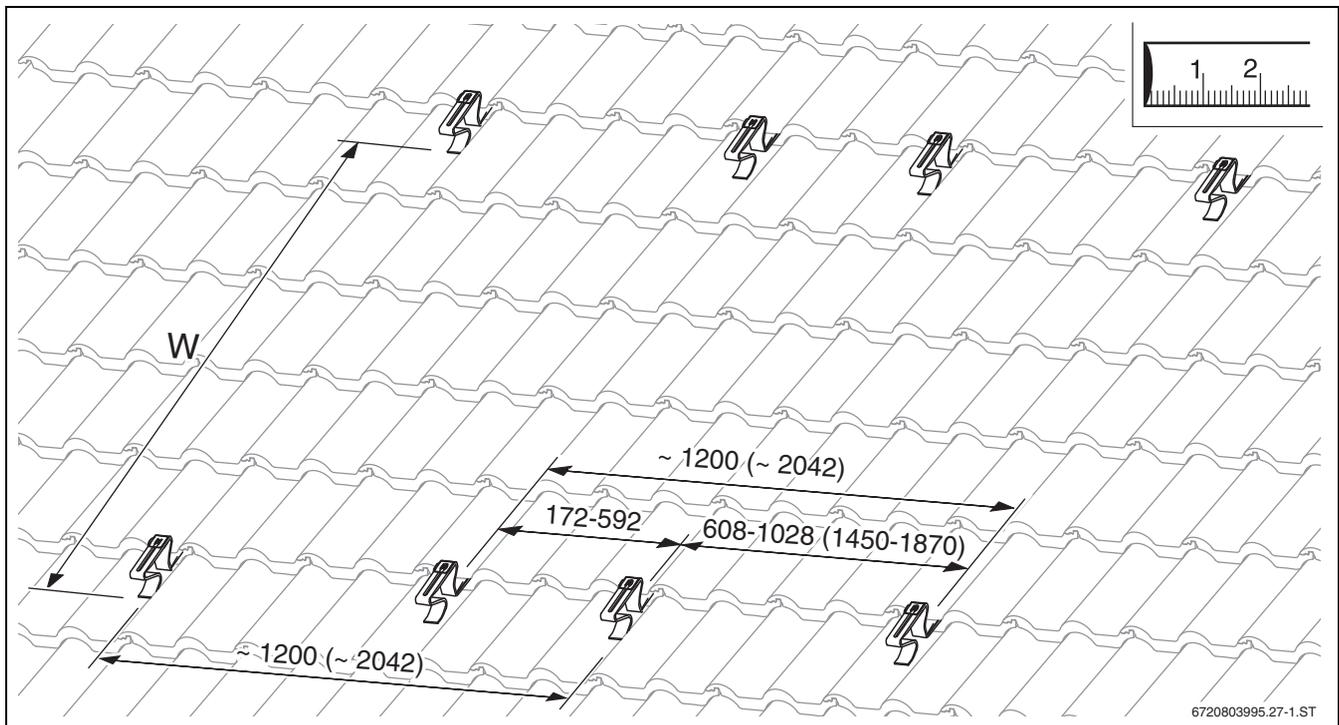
Dachhaken für zwei Kollektoren (Maße in Klammern beziehen sich auf waagerechte Kollektoren; Maße in mm)
